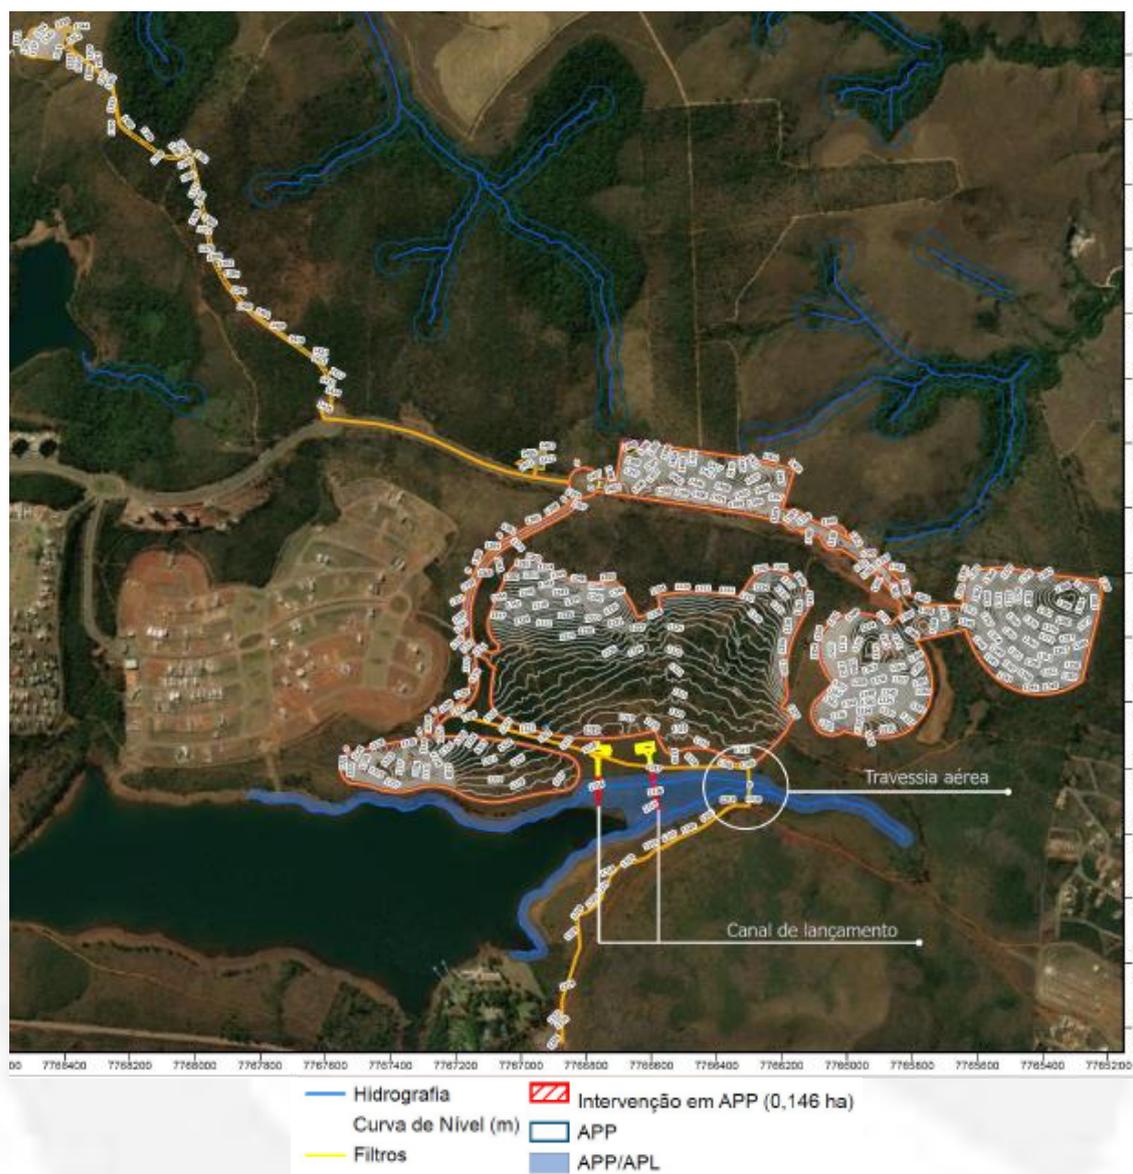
Localização da área de intervenção em APP para instalação dos canais do sistema de drenagem.
